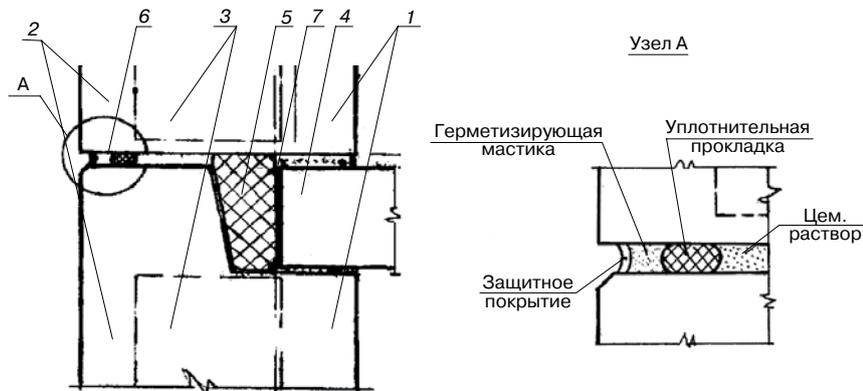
Существующий платформенный стык между наружными панелями: 1 – внутренние железобетонные несущие слои; 2 – наружные железобетонные ограждающие слои; 3 – теплоизоляционные слои; 4 – плита перекрытия; 5 – теплоизоляционный вкладыш; 6 – гидроизоляционный участок (узел А); 7 – растворные швы
